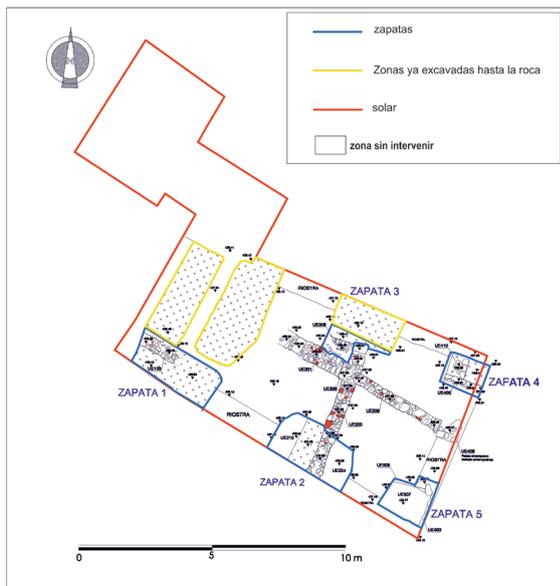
Solar y zonas excavadas. En azul zonas de las zapatas de cimentación excavadas parcialmente en nuestra intervención. En amarillo zonas ya vaciadas previamente. En blanco zonas no intervenidas.
